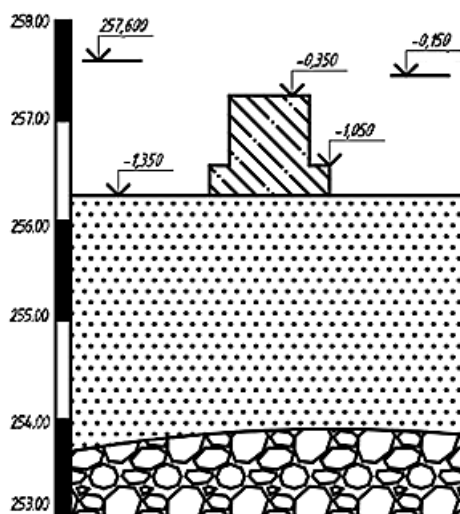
Схема розташування фундаментів, відносно відміток
